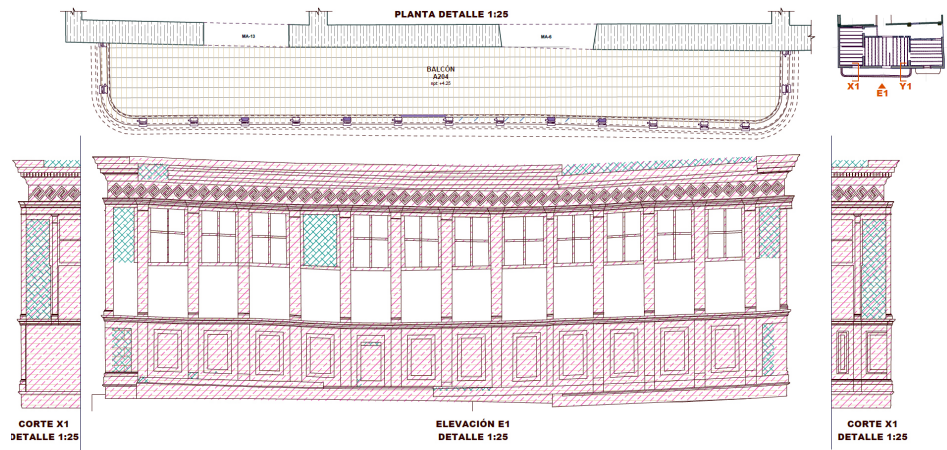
Planimetrías del balcón de la Casona Jr. Trujillo
